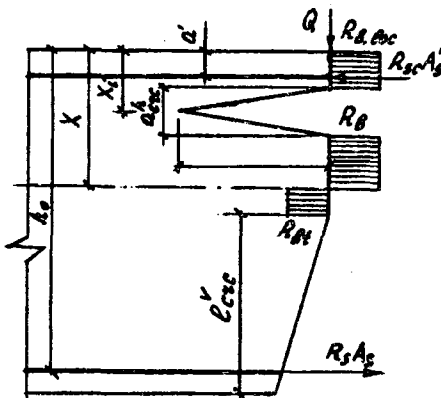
Схема к расчету изгибаемого железобетонного элемента
